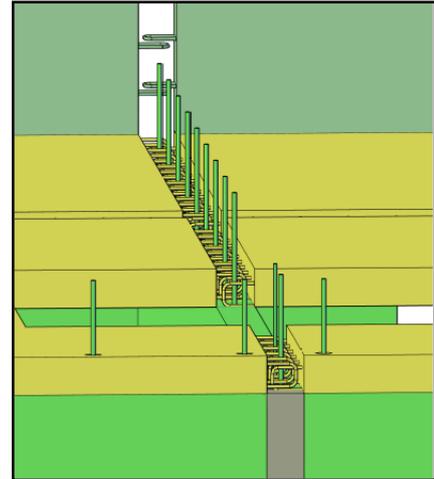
Proceso de armado de paneles prefabricados de hormigón
